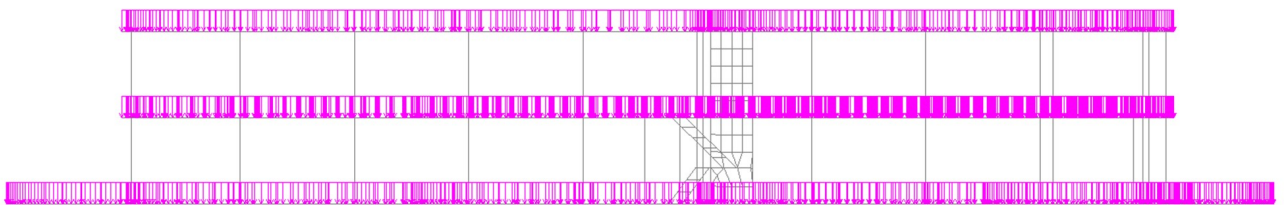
Схеми завантажень будівлі від ваги підлог та покрівлі
